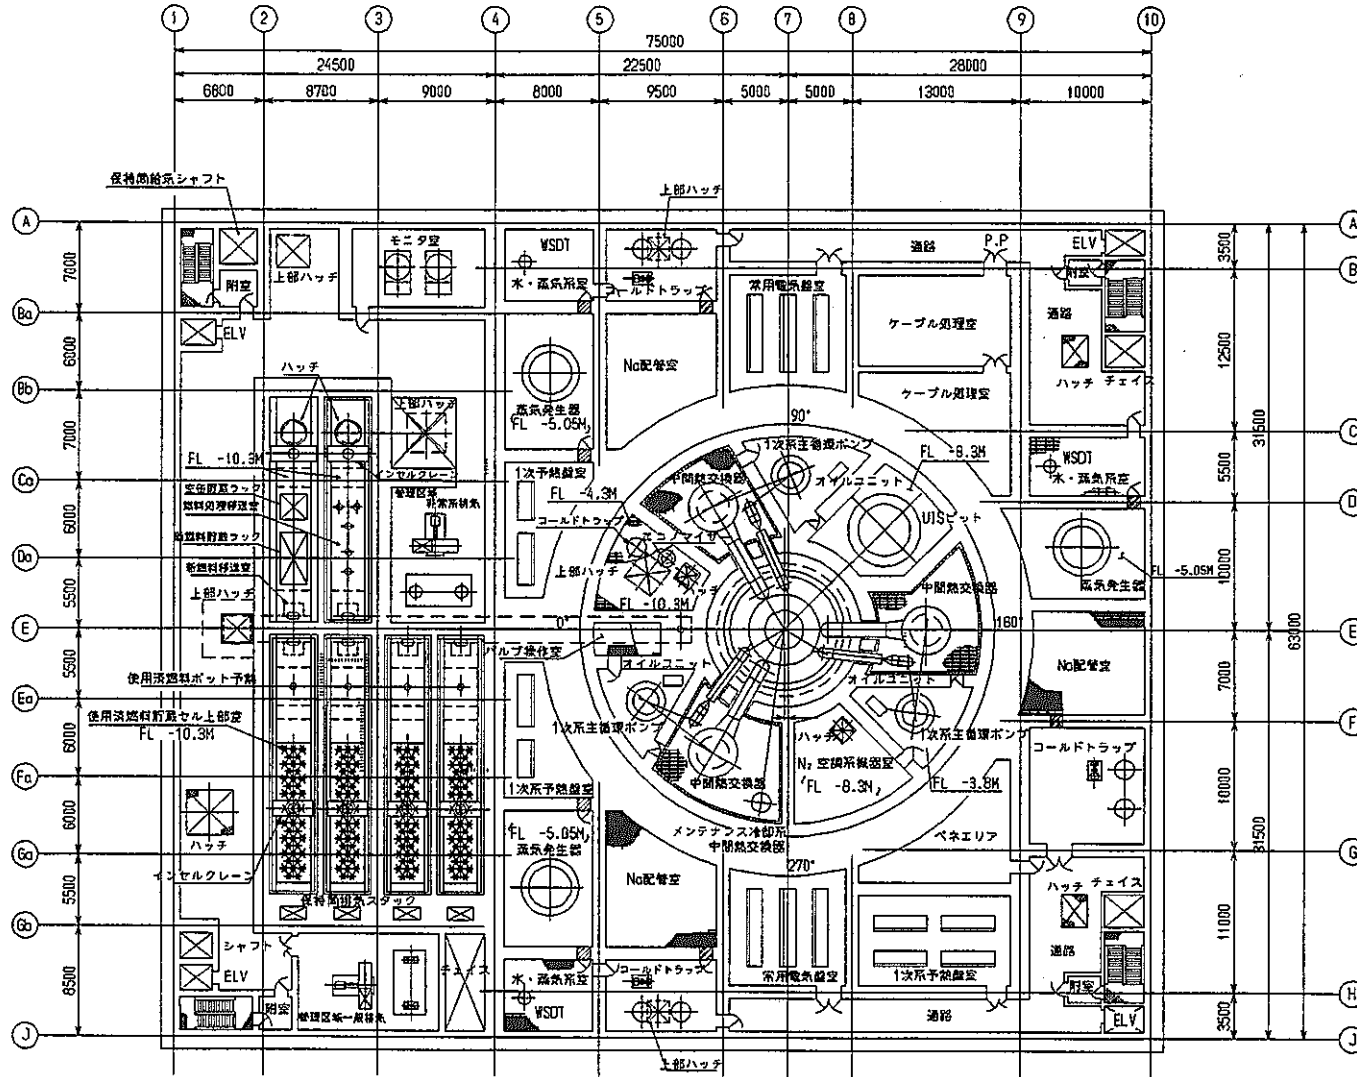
原子炉施設全体機器配置図 (FL-8.3 M (B1 F))
